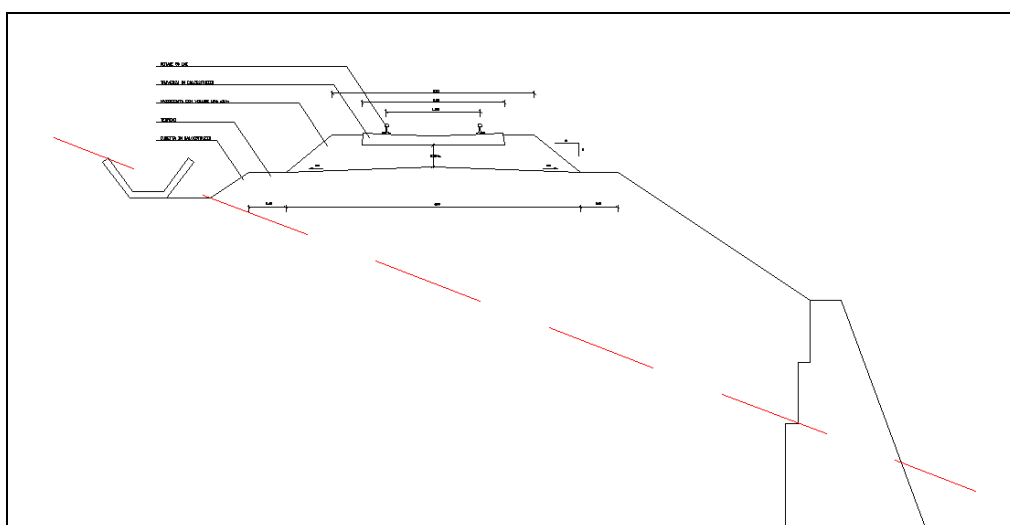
Sezione trasversale rilevato ferroviario con muro di sottoscarpa
